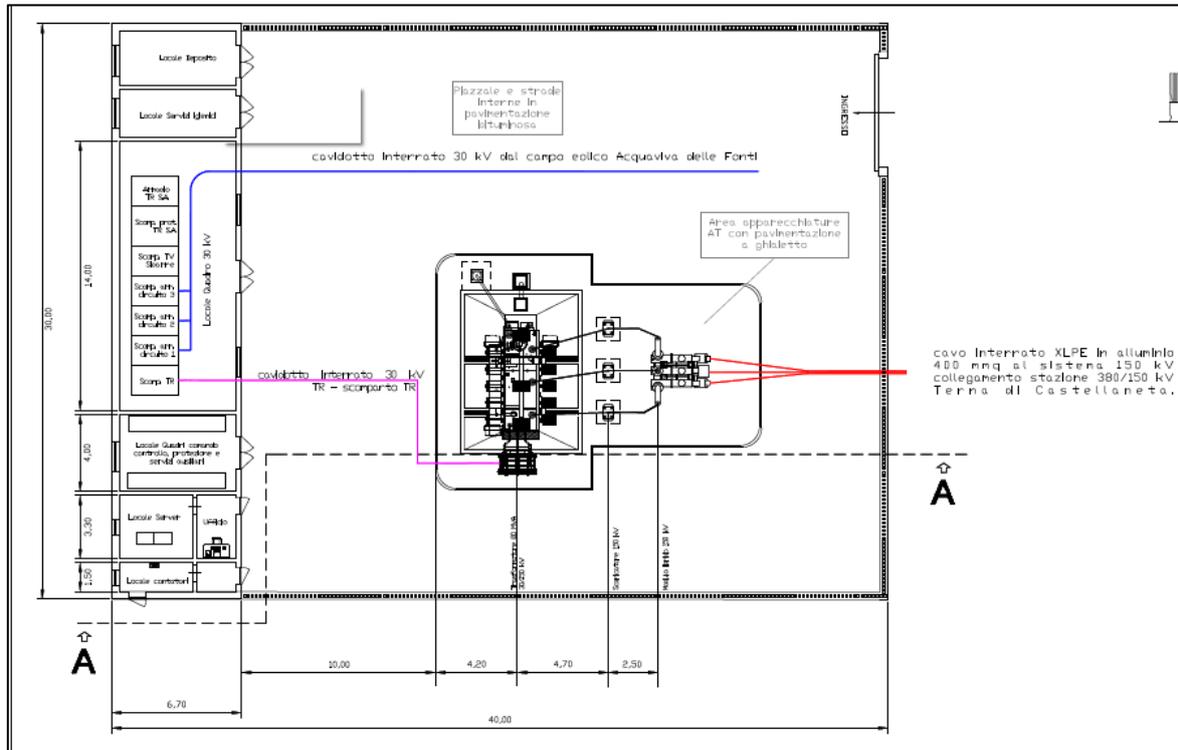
Planimetria stazione di trasformazione 30/150 kV
